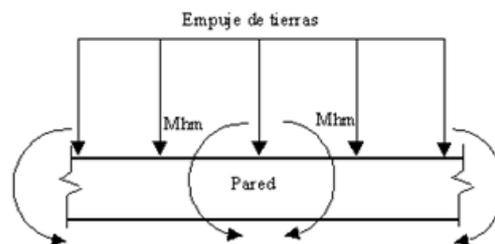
Sección en Planta de la Pared. Empuje del terreno sobre la CÁMARA
